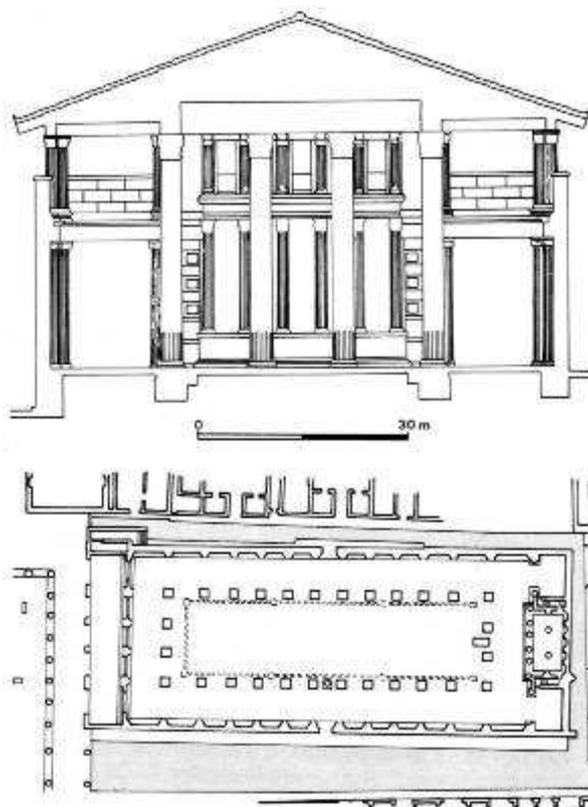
Basilica di Pompei. Pianta e sezione trasversale ricostruttiva (GROS 1987)
